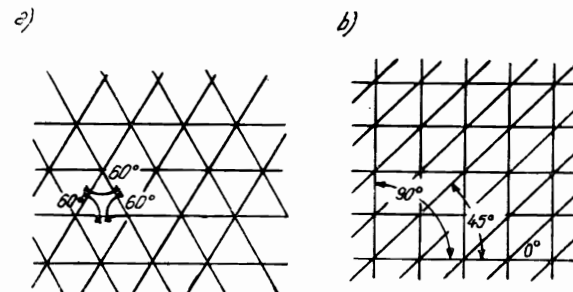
Aranjarea corzilor pe paramenți pentru măsurarea deformațiilor :
